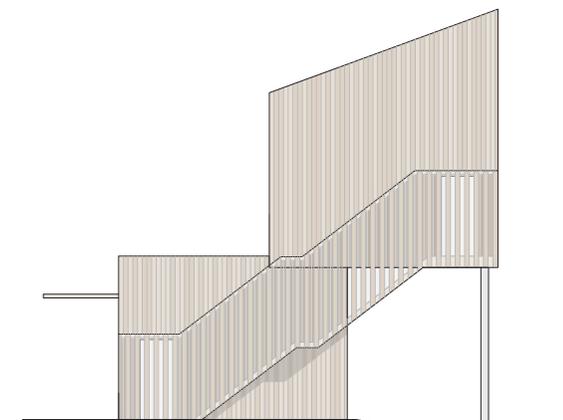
Prospetto ovest. Scala 1:200
